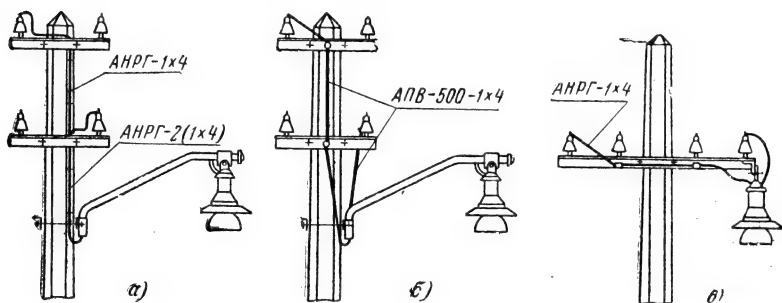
Установка светильников наружного освещения с лампами накаливания на железобетонных опорах.
